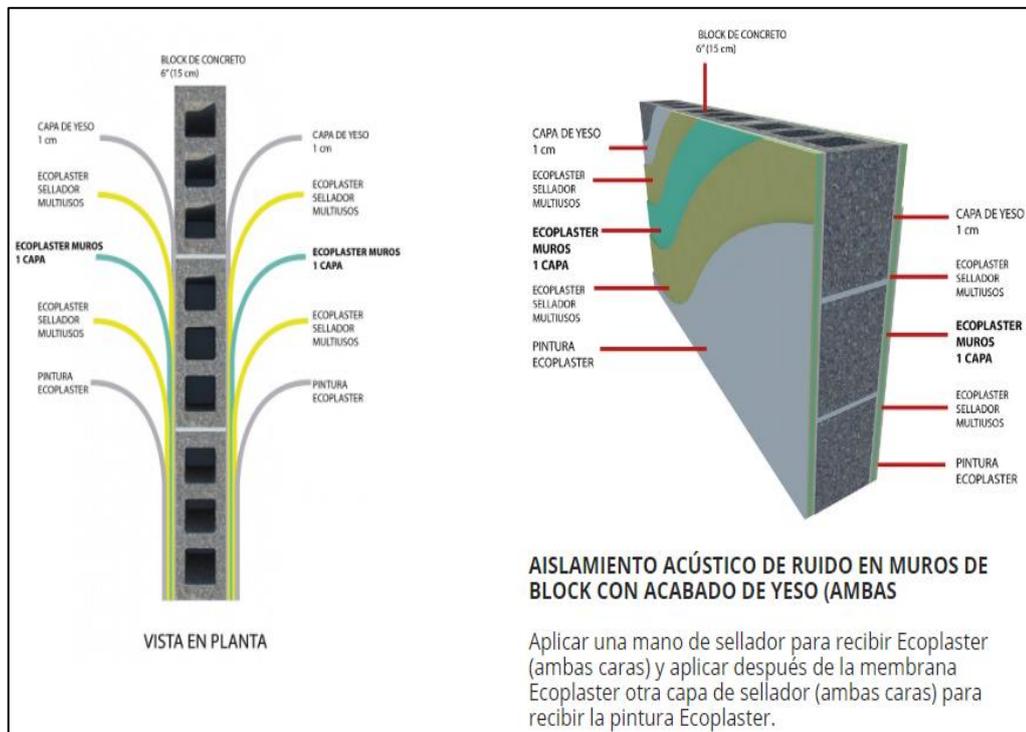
Propuesta de Muros de Aislamiento Acústico en Muros
